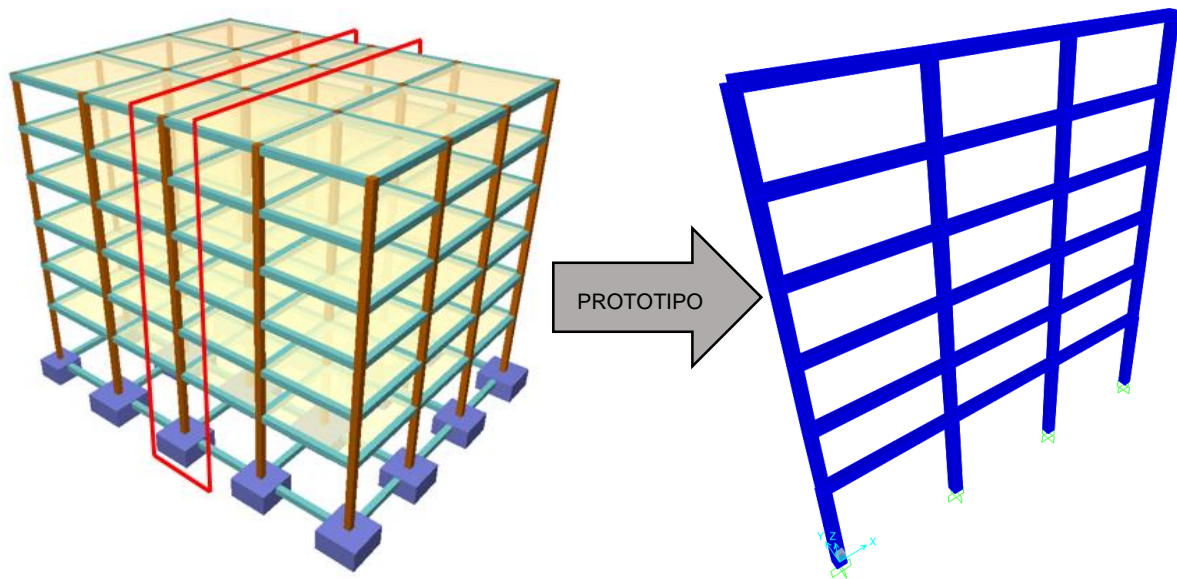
Prototipo estructura. Pórtico plano de hormigón armado
